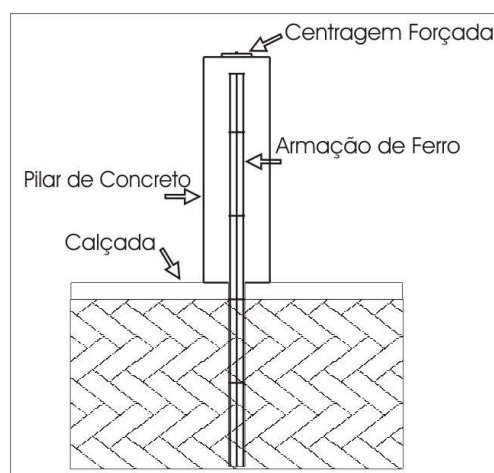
Projeto do Pilar da Rede de Monitoramento
